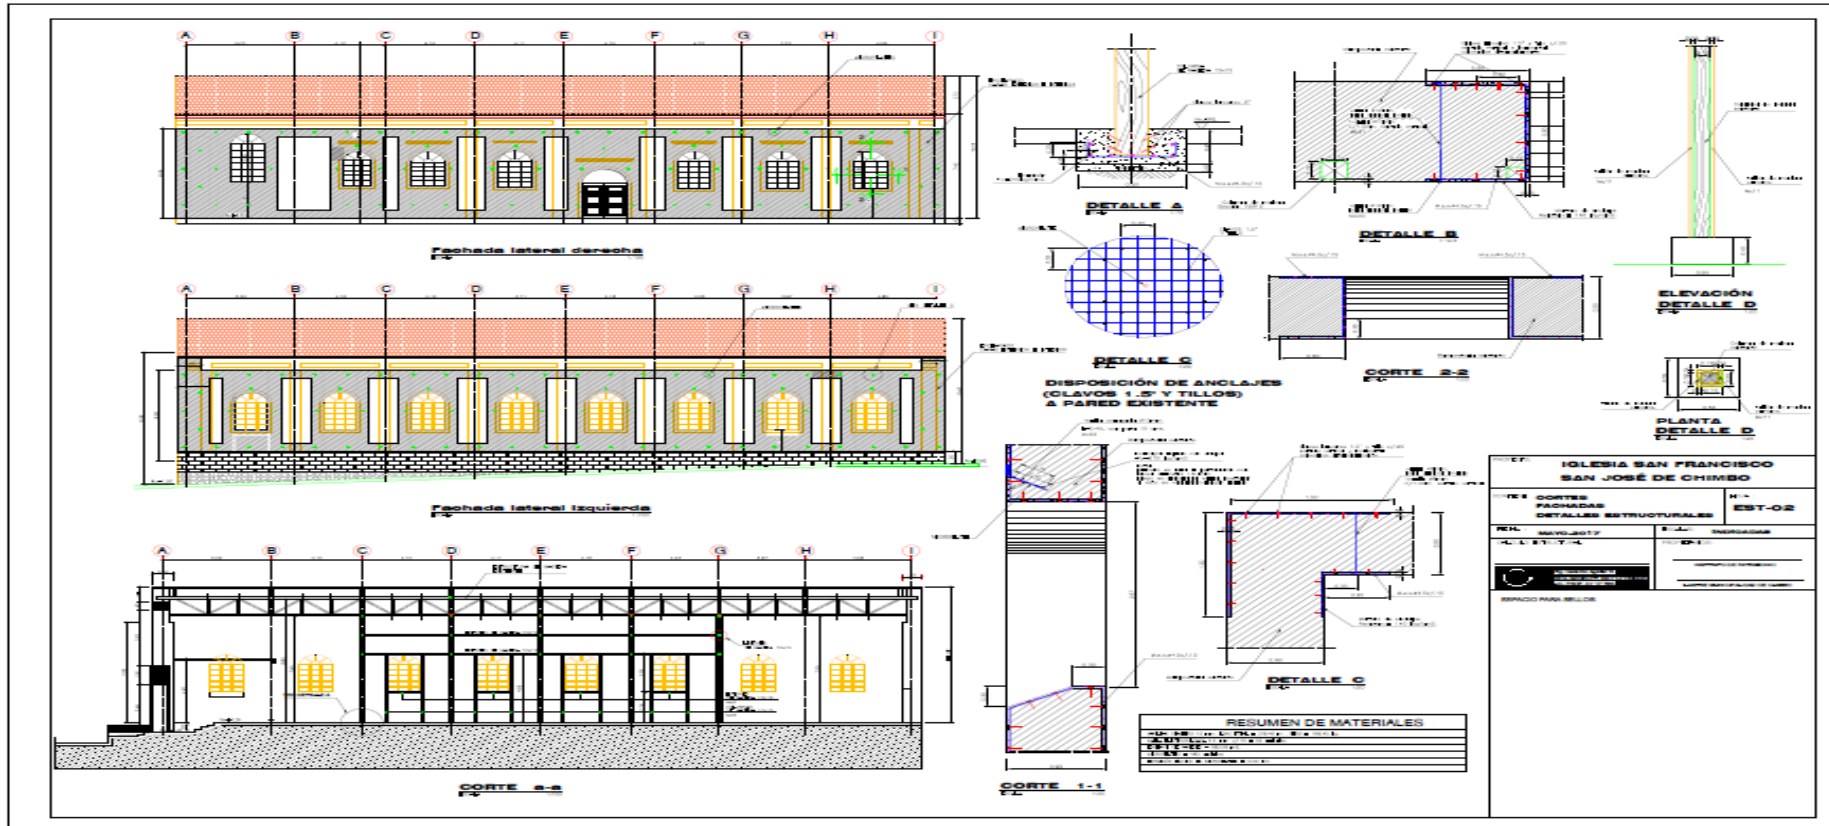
Plano de Reforzamiento fachada lateral derecha e izquierda
